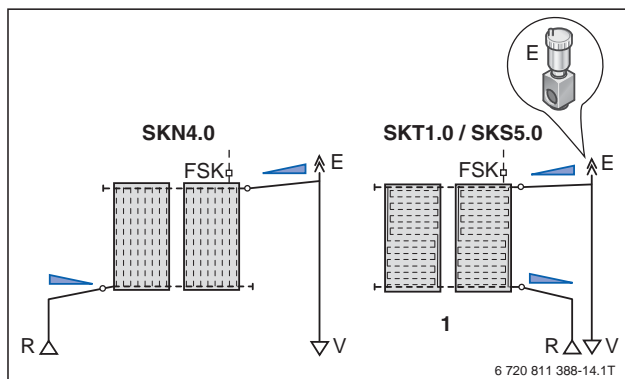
Hydraulikschema mit Entlüfter am höchsten Punkt der Solaranlage
